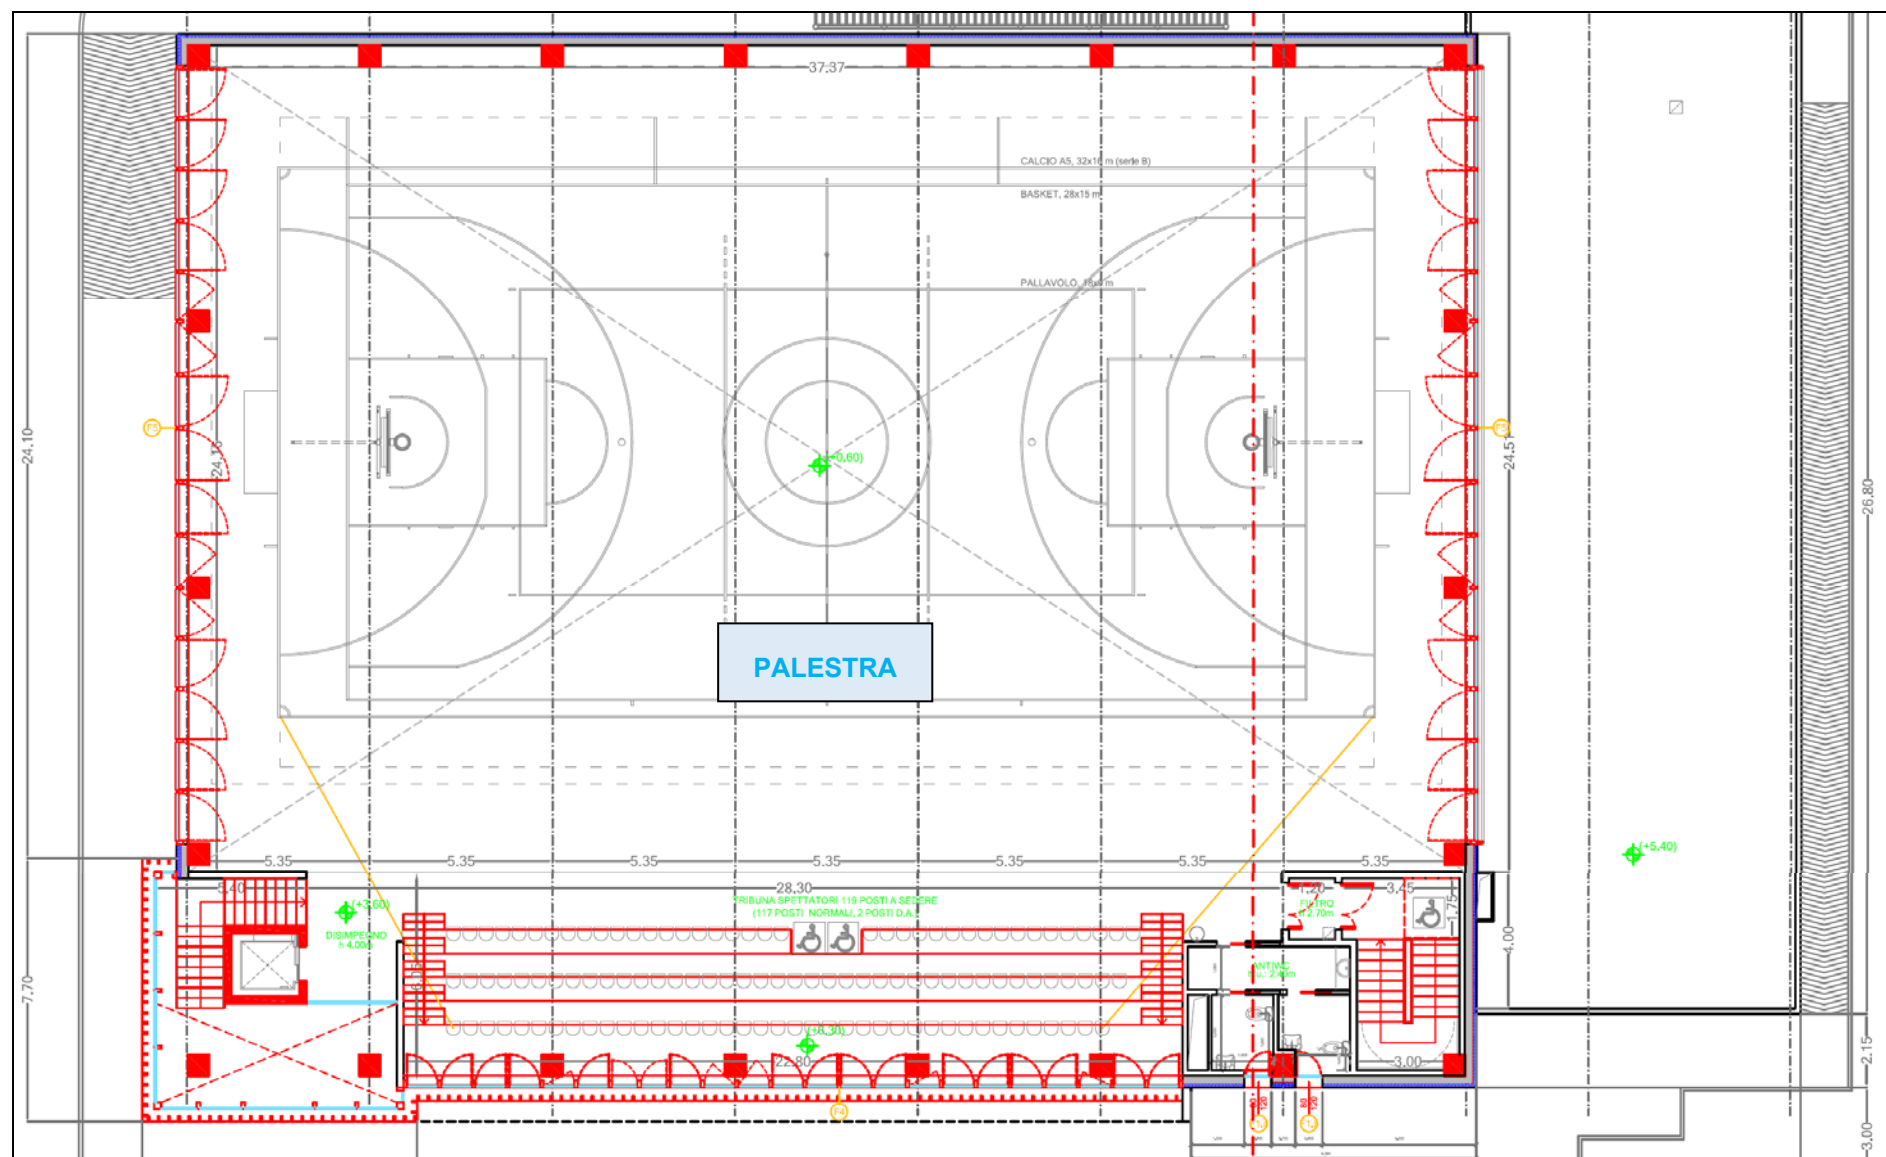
Planimetria del primo piano della palestra con identificazione degli ambienti oggetto di verifica
